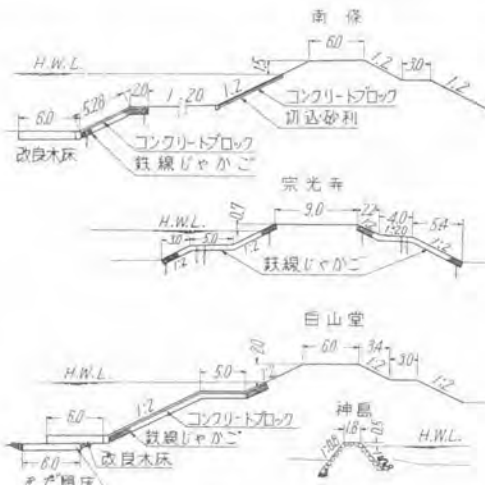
(ロ) 大仁橋下流部の堤防標準断面図
